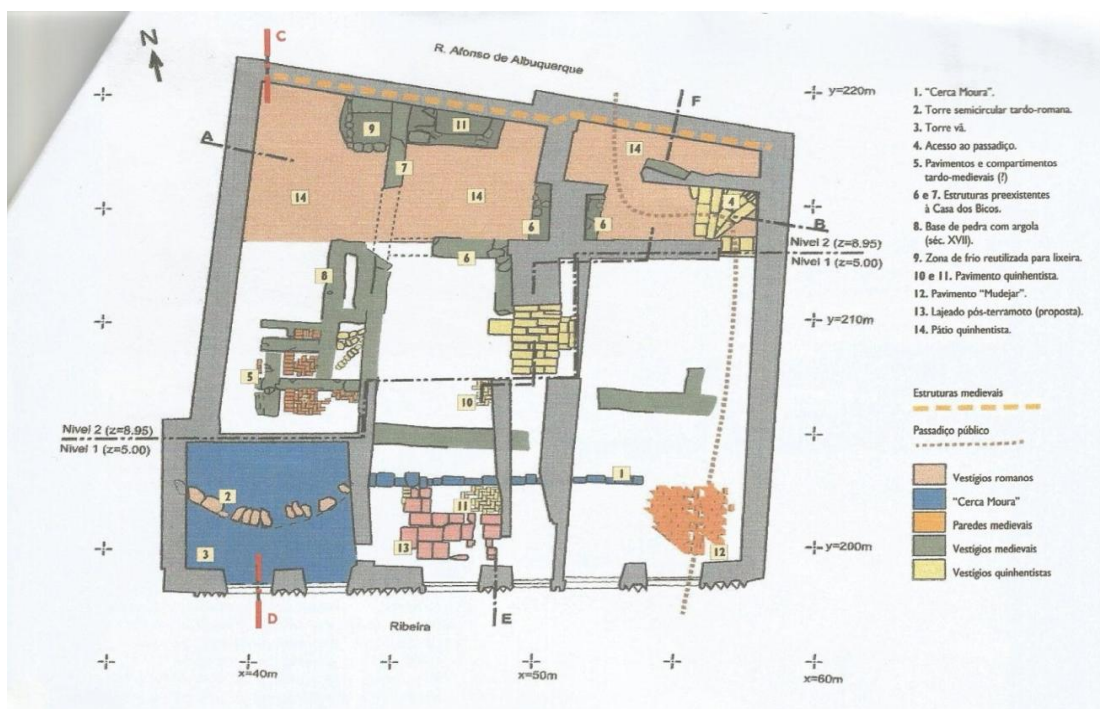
Desenho da plana da escavação (Fonte: Sepúlveda e Amaro, 2007:3).
